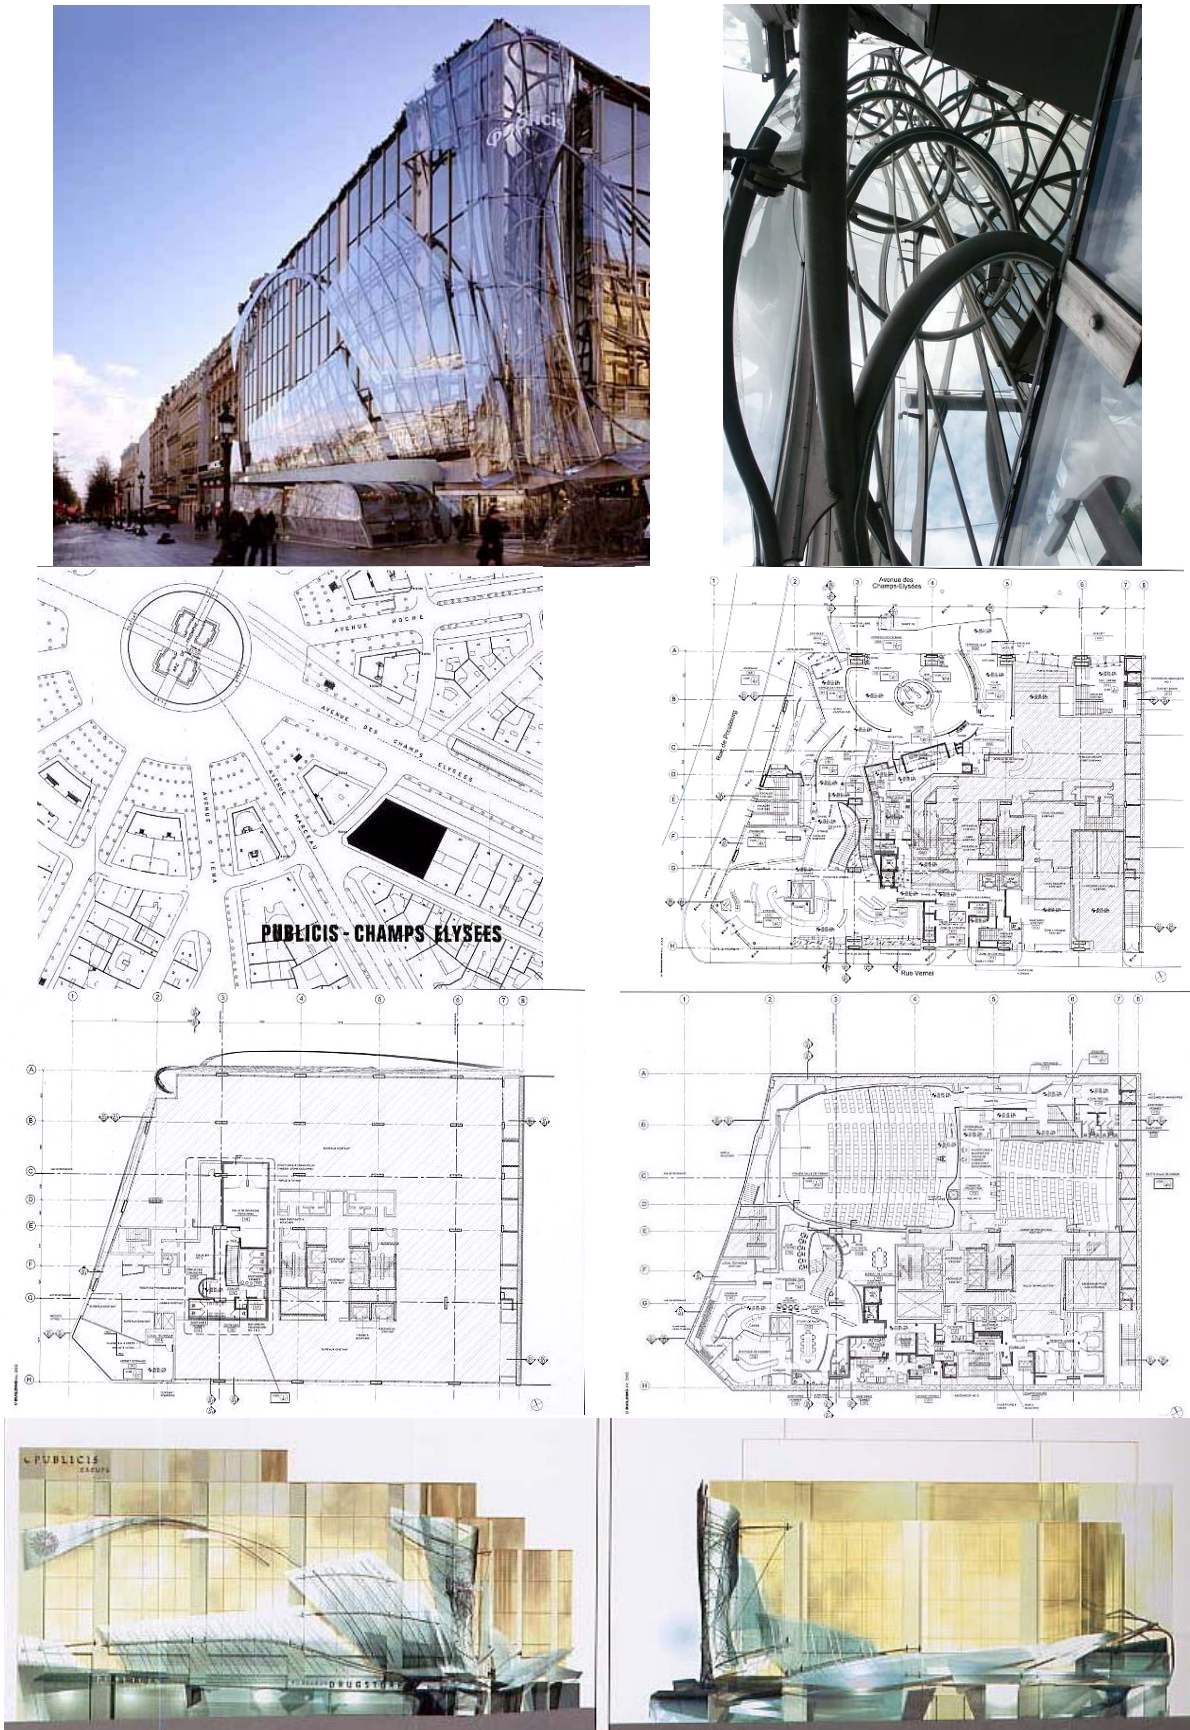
П11. Реконструкция фасада Pablicis Drugstore, Париж (Франция) [9, 49]
